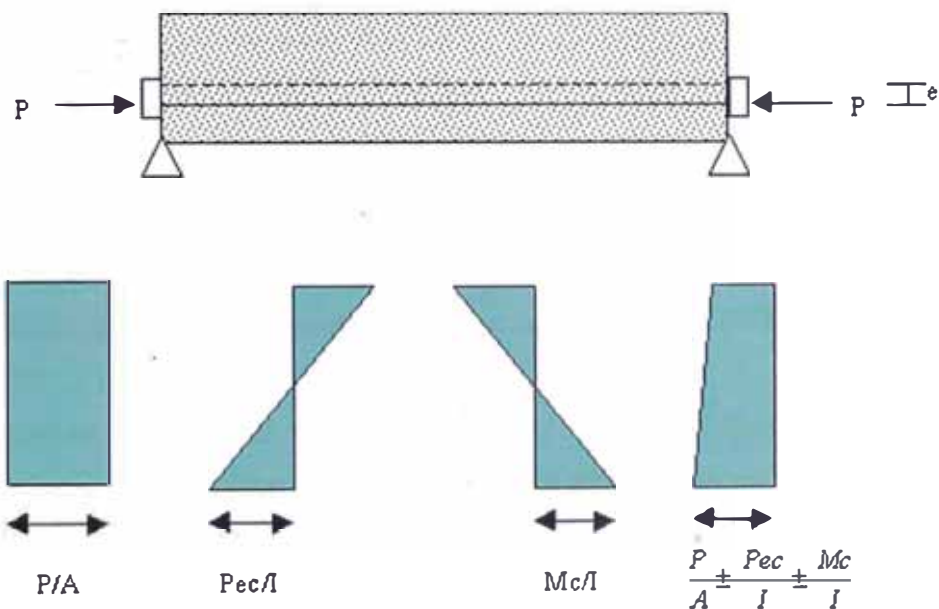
Distribución de esfuerzos a través de una sección de concreto preesforzada excéntricamente
